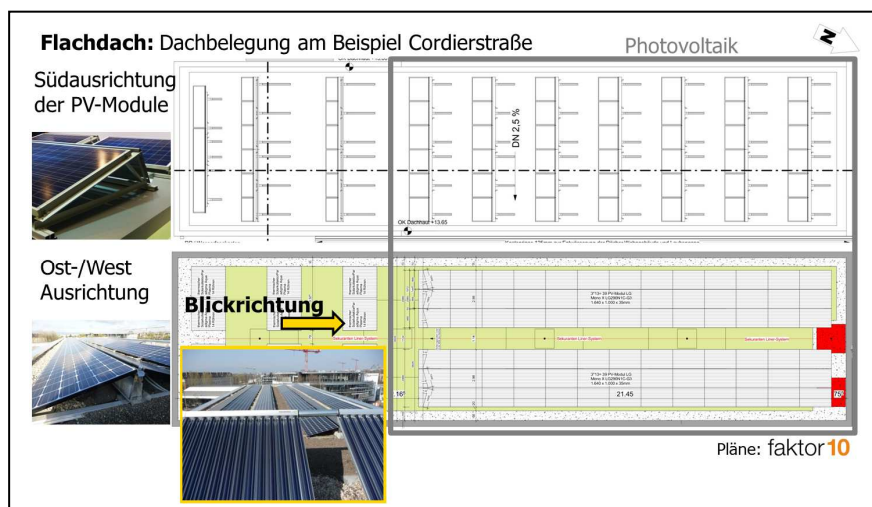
Dachbelegung eines Flachdachs mit Photovoltaik
